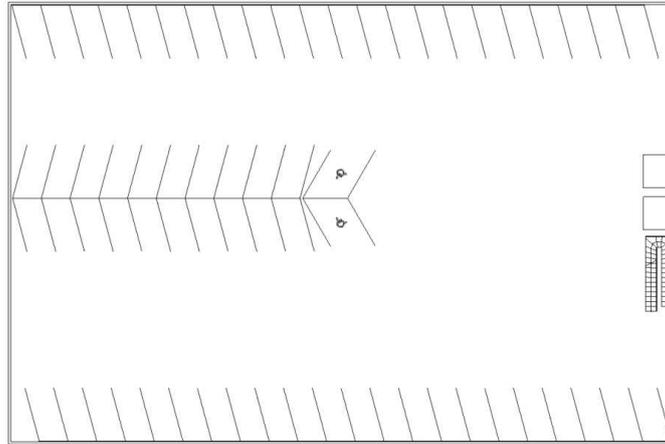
Grundriss EG BIM-Modell WGarG §8 Abs 1
